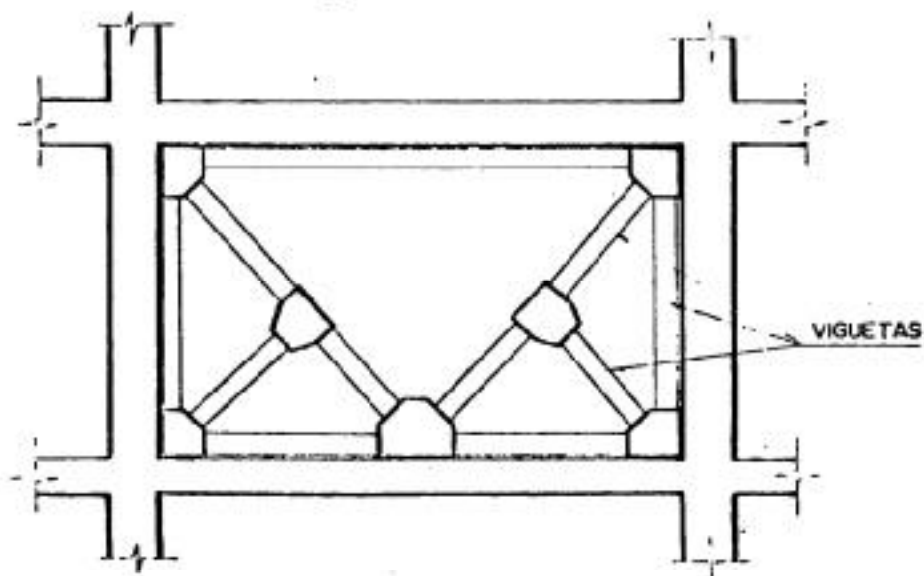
Alternativa de contraventeo con perfiles metálicos (ref. 4)
